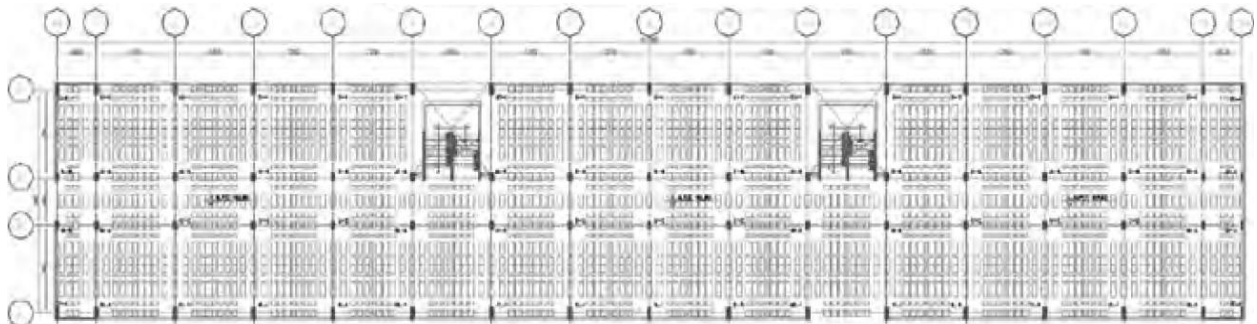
Vista de una Planta Tipo estructural del Edificio G, tomada de presentaciones de Tena Colunga (2021).
